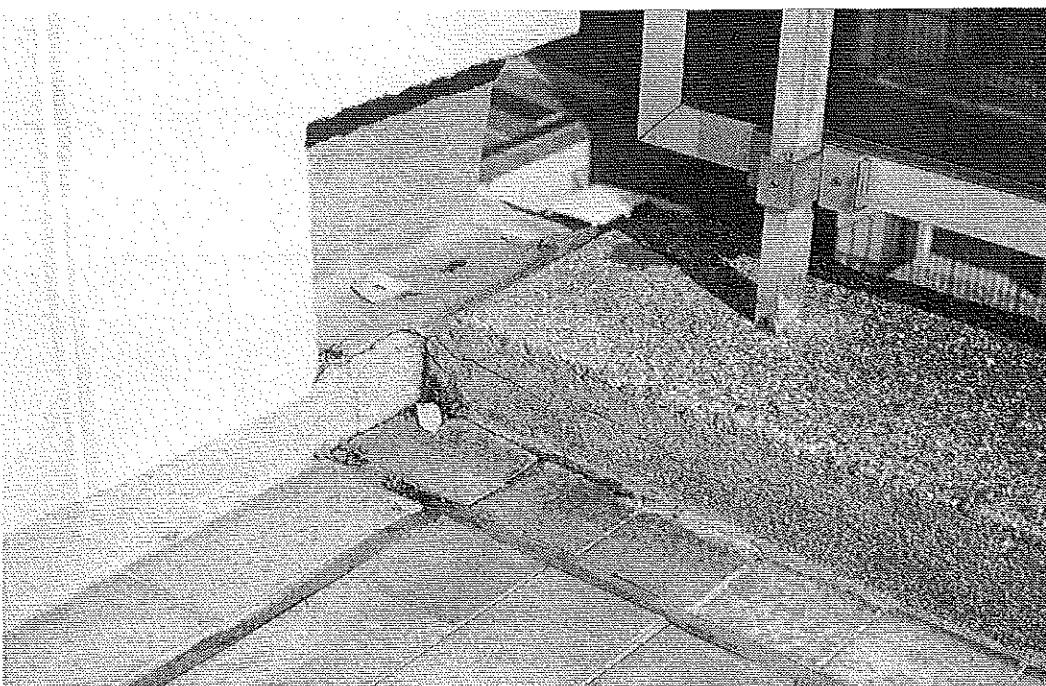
Fissuration socle. Décollement carreau d'angle. Raccordement non achevé (pierre d'angle). © J. Putatti
